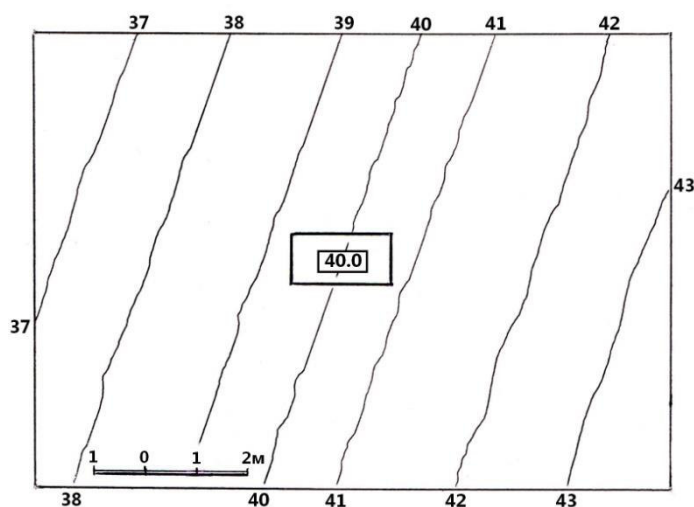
До побудови меж земляних робіт укосів будівельного майданчика
